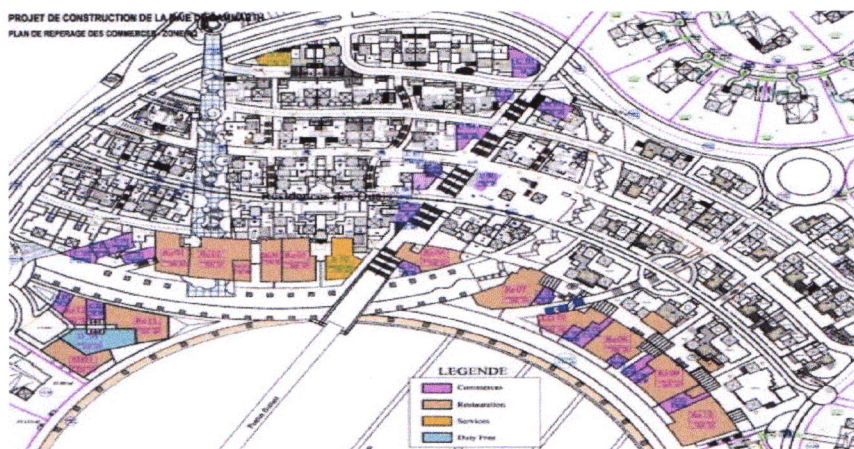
Plan de repérage des commerces du complexe (source mémoire village touristique balnéaire au andalouse 2014)
